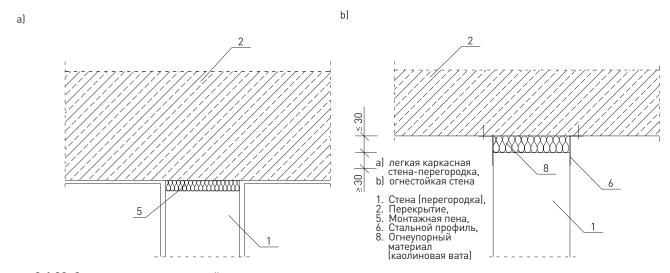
Соединение заполняющей стены или перегородки с перекрытием
